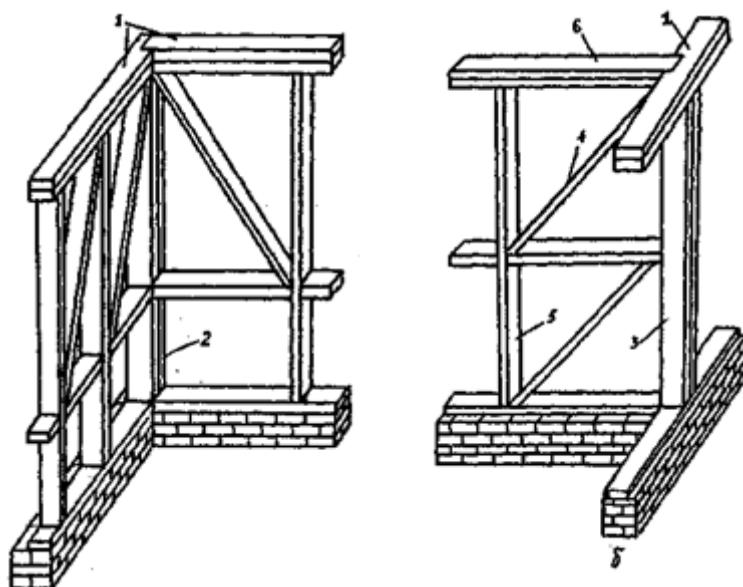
Элементы каркаса наружных и внутренних стен: 1, 6 – верхние обвязки; 2 – угловая стойка; 3,5 – стойки внутренней стены; 4 – подкос
